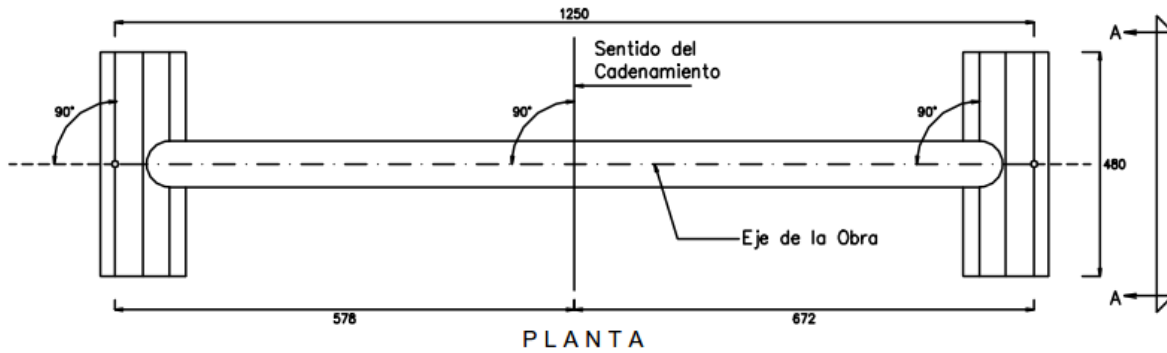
Planta de la obra de drenaje proyectadas con una línea de tubería de concreto de 1.20 mts de diámetro.
